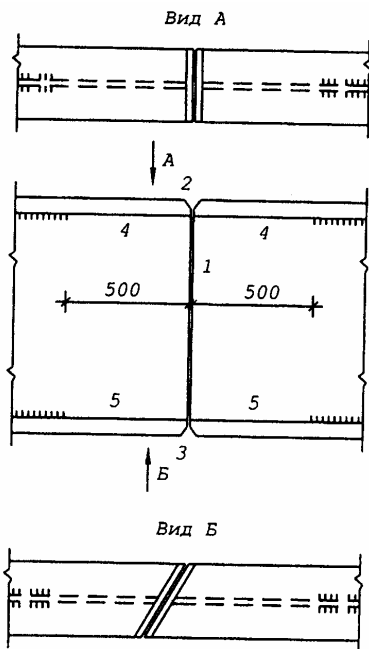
Конструкція зварного стику балки складеного перерізу:
